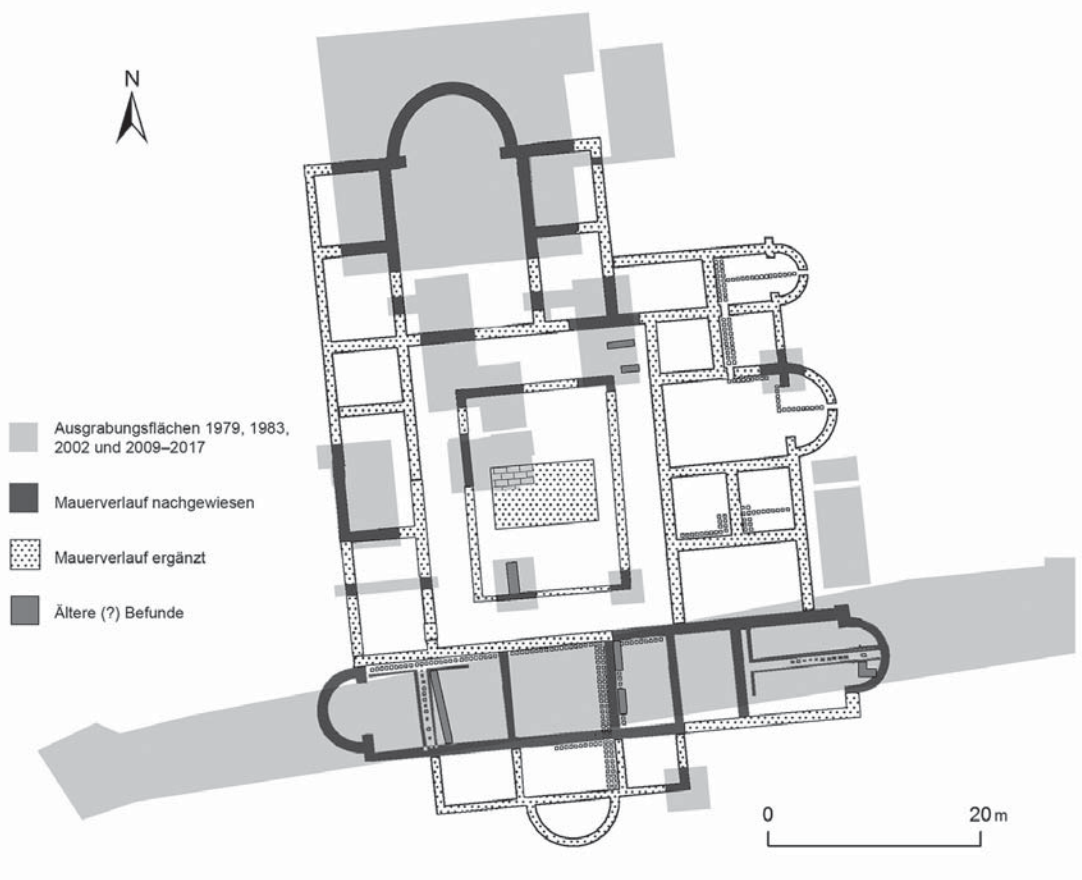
Rekonstruierter Grundriss der Bauphase A (Vorfestungsbauzeit) des Gebäudes 25 (Grafik: Autoren)
